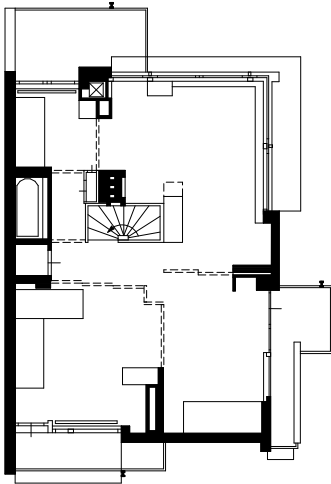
Schröder-Haus in Utrecht Obergeschoss mit offenen Raumteilern
